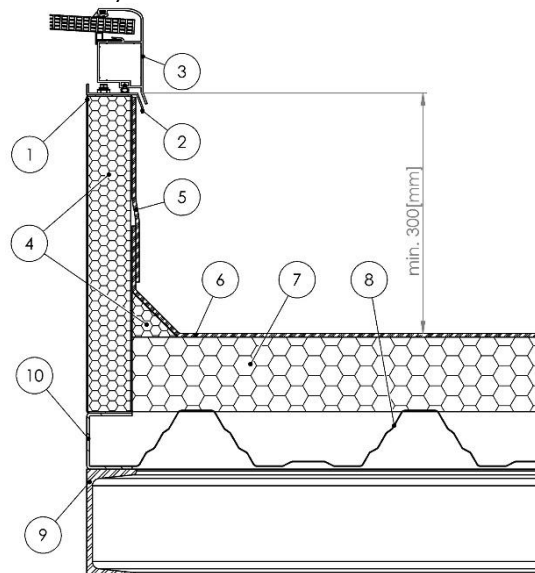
Montaż klapy SCD-1-L na izolowanym dachu stalowym, bez podkonstrukcji, pod blachą trapezową
